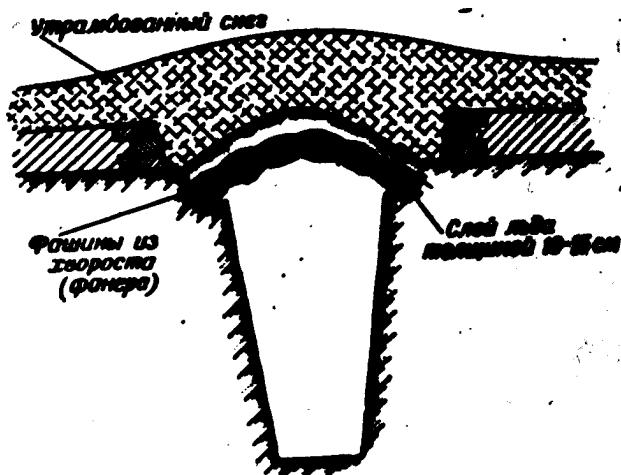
Перекрытие траншей или окон, сделанное из снега
